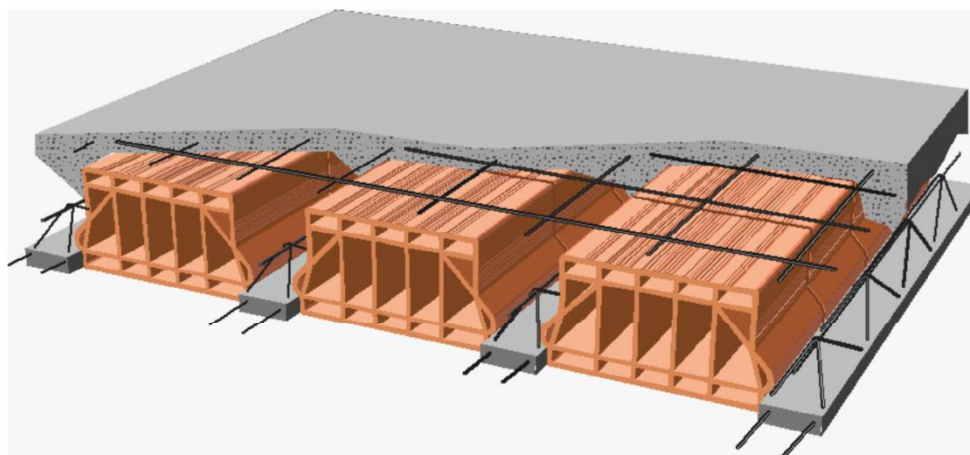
Esempio di solaio in cemento armato a travetti tralicciati e blocchi interposti
